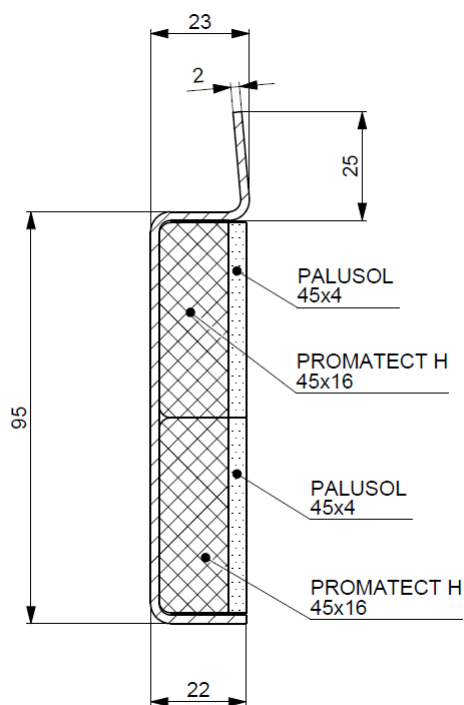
Brama RGS 120 – przekrój lameli pośredniej
